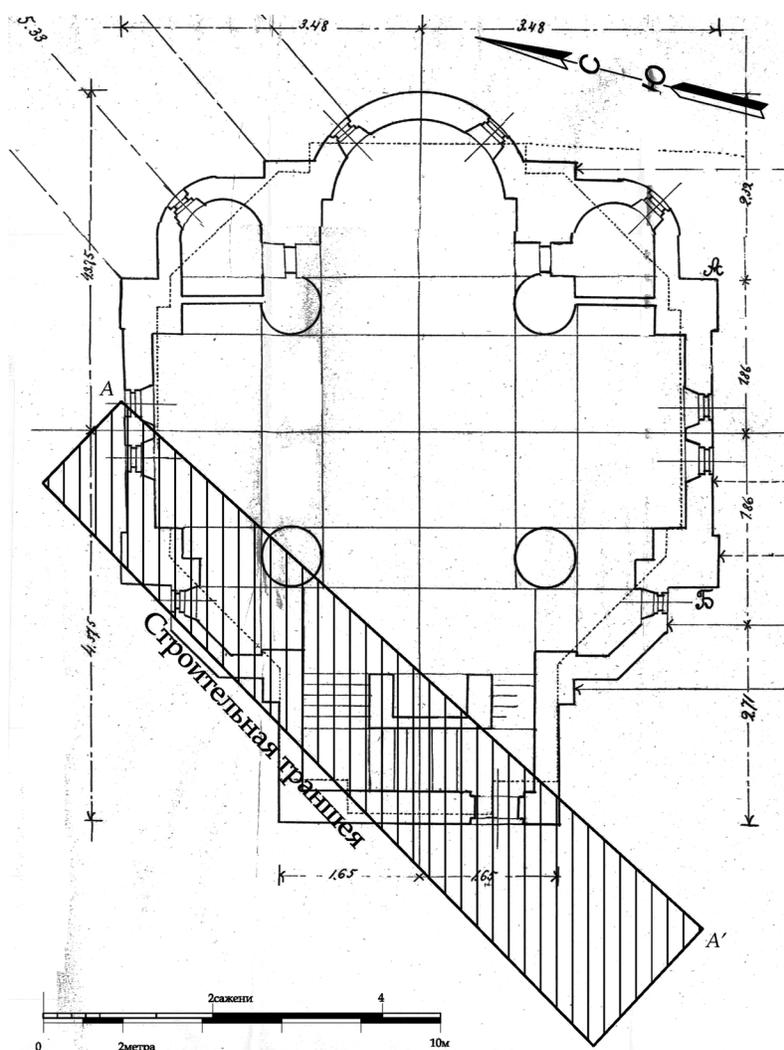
План фундамента храма, выполненный по заказу Городской Управы в 1914 г. с указанием строительной траншеи 2009 г. (ИПГД. 1914. № 38)
